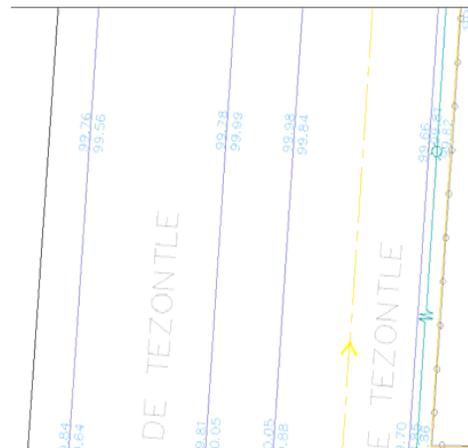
Niveles en guarnición, calles, camellón. Sentido de la red de drenaje (amarillo). Av. Canal de Tezontle.
